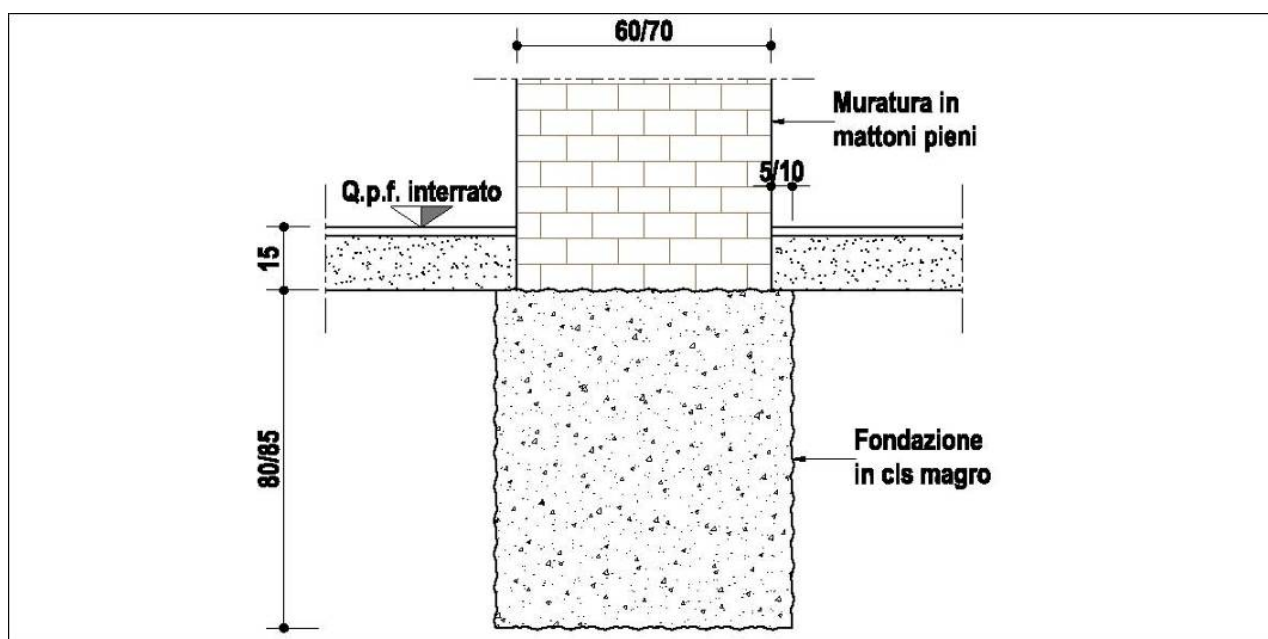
Fondazioni – Corpo di collegamento est
